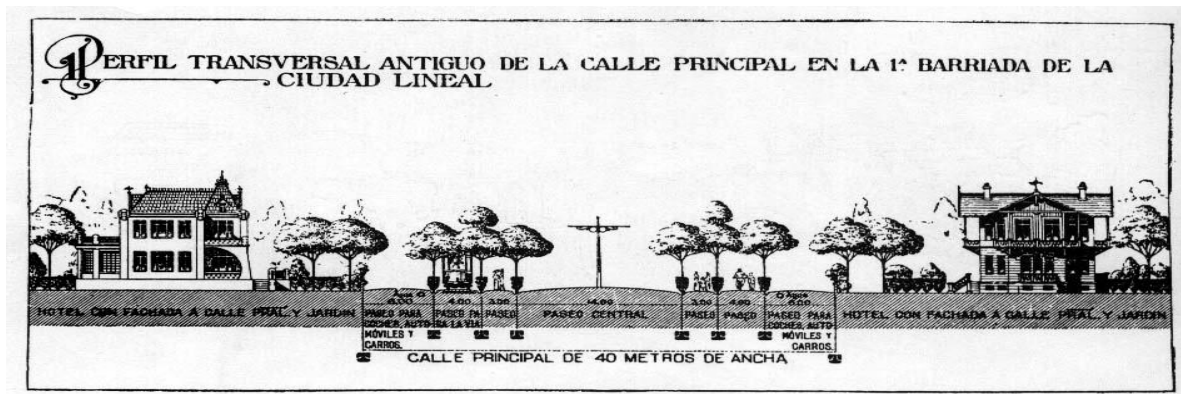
Arturo Soria. 1886. Perfil Transversal. Proyecto de Ciudad Lineal para Madrid
